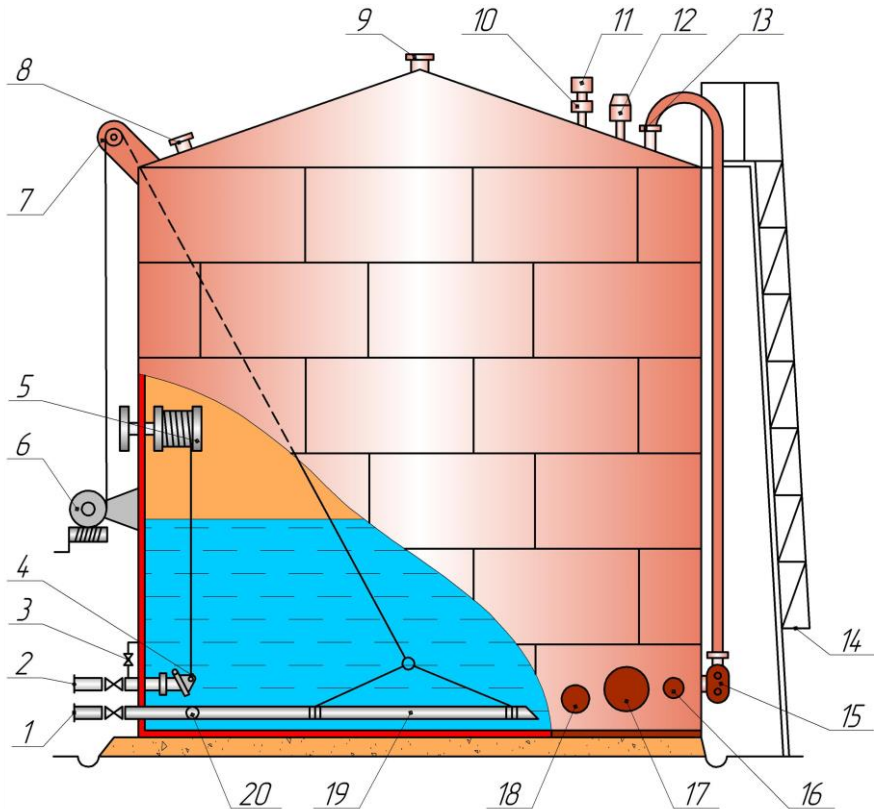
Вертикальний сталевий нафтовий резервуар:
